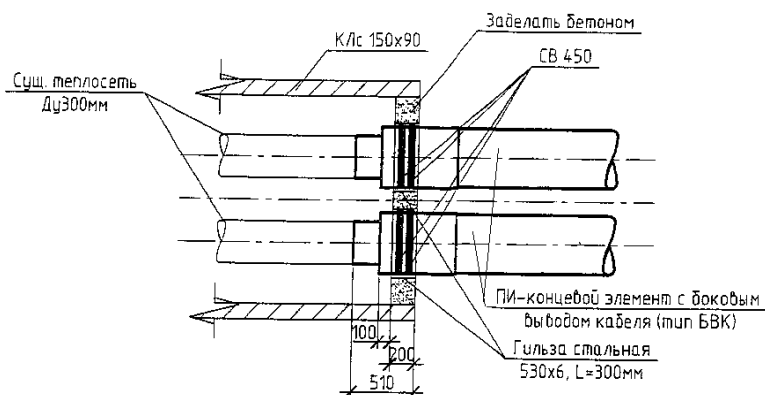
Соединение теплопроводов в железобетонном канале
